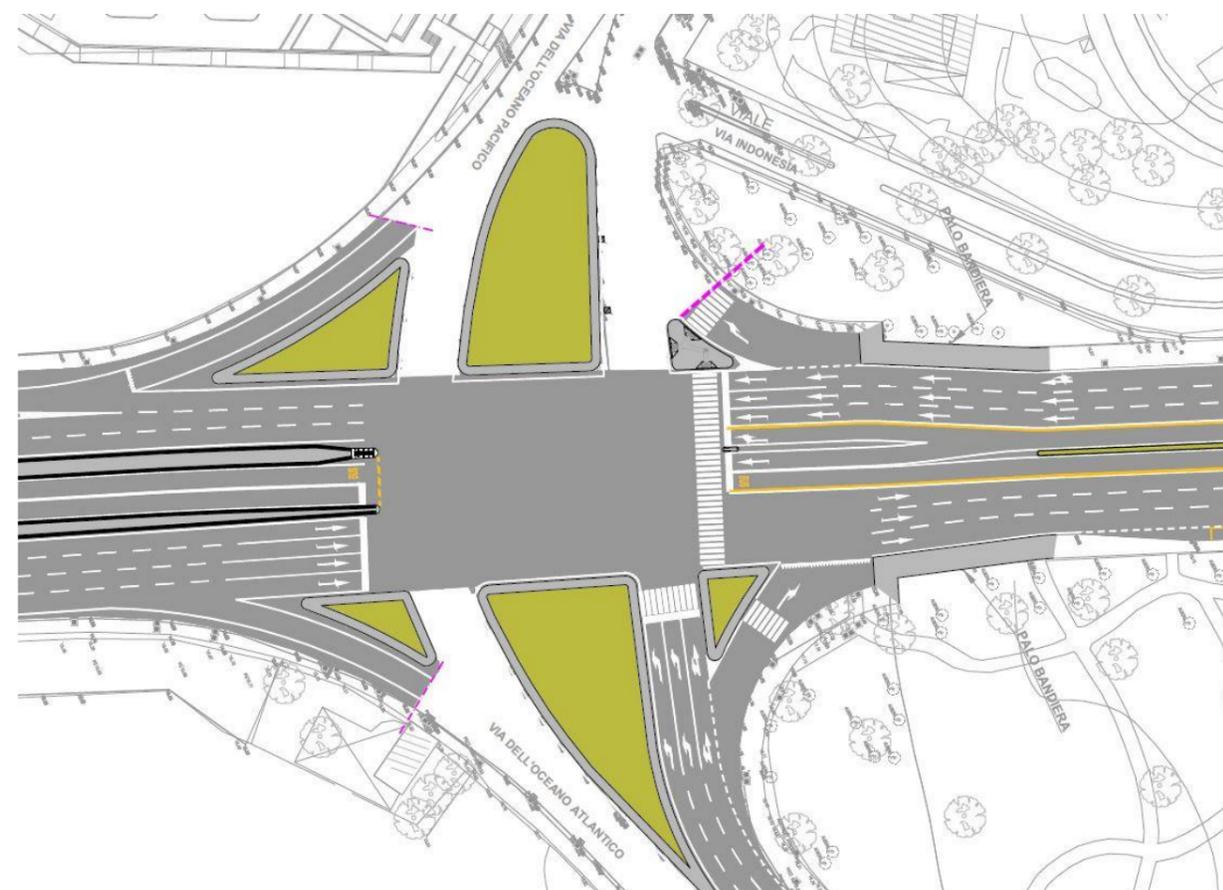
stralcio planimetrico sistemazione piazzale 25 Marzo 1957
